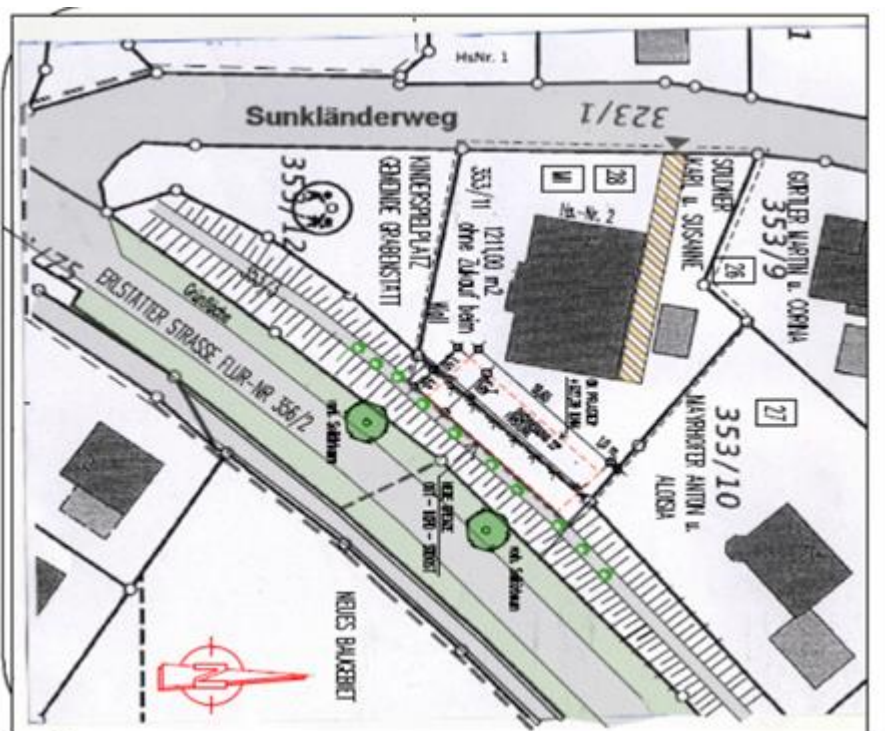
Geplante Änderung des Bebauungsplans Grabenstädt - Nickelberg. Auszug aus der Bebauungsplanänderung Söldner vom 31.10.2021;
